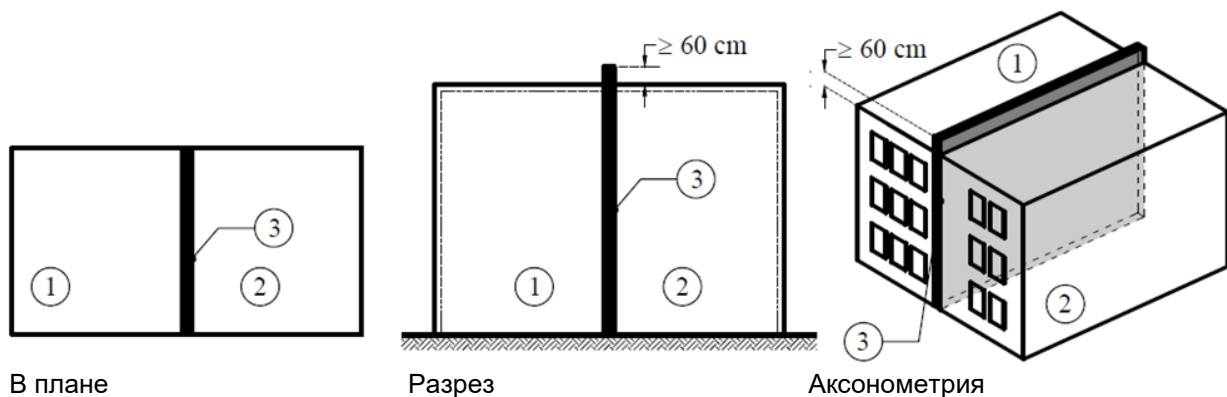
Разделение пожарных отсеков по высоте путем возвышения противопожарной стены над кровлей не менее чем на 60 см
